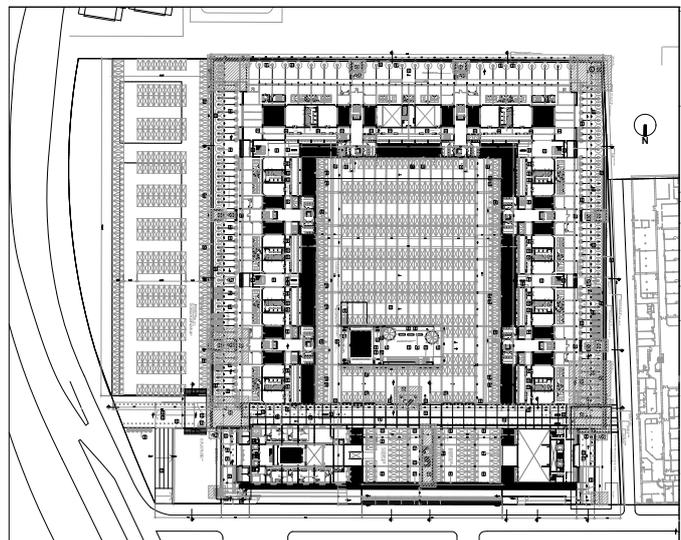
Diagrama de la planta del proyecto arquitectónico del CJS. Imagen 36. Planimetría de la planta del proyecto arquitectónico del CJS.
